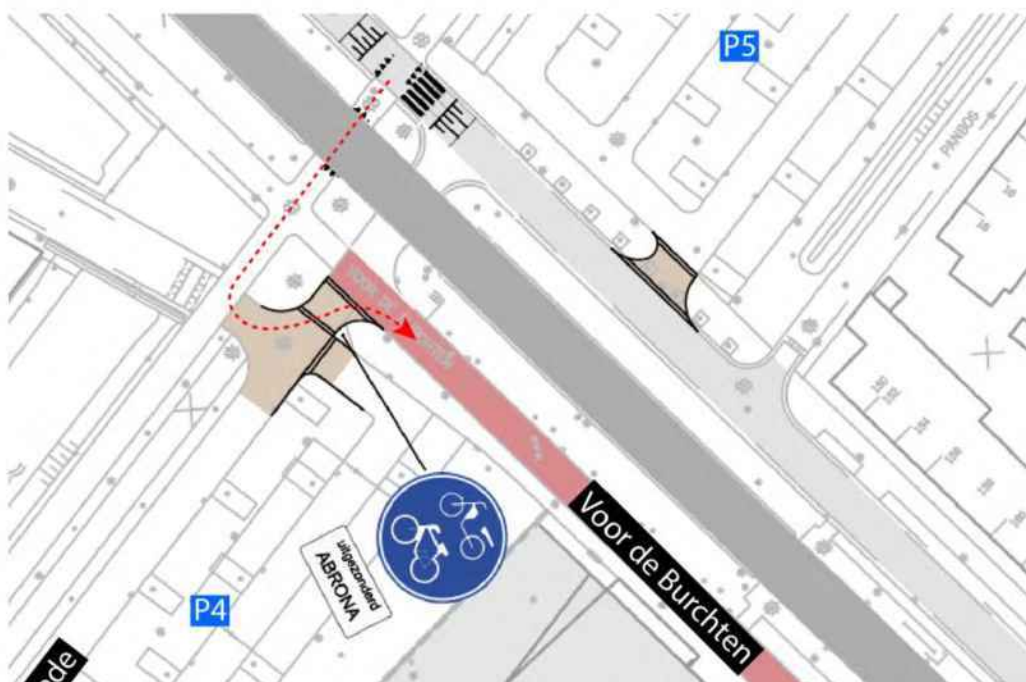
Suggestie van oversteek tussen P4 en P5 vanaf de Burchtpromenade, door voorrangsborden en betonnen klinkerverharding in de berm.
